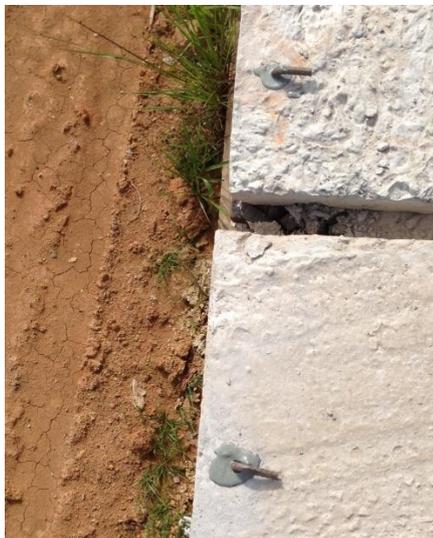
Fixação da laje à parede com barra de aço e adesivo estrutural
